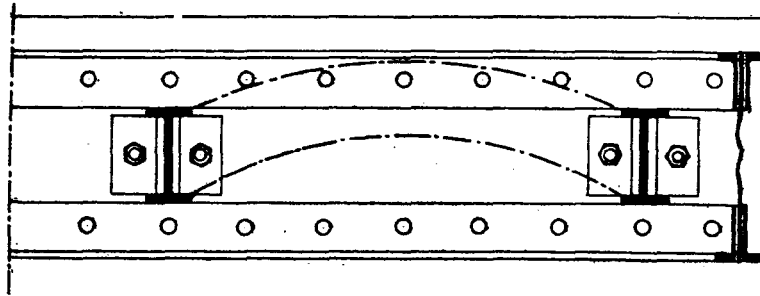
Viguetas ensambladas a la viga maestra: caso de bovedillas con solado de cemento.
